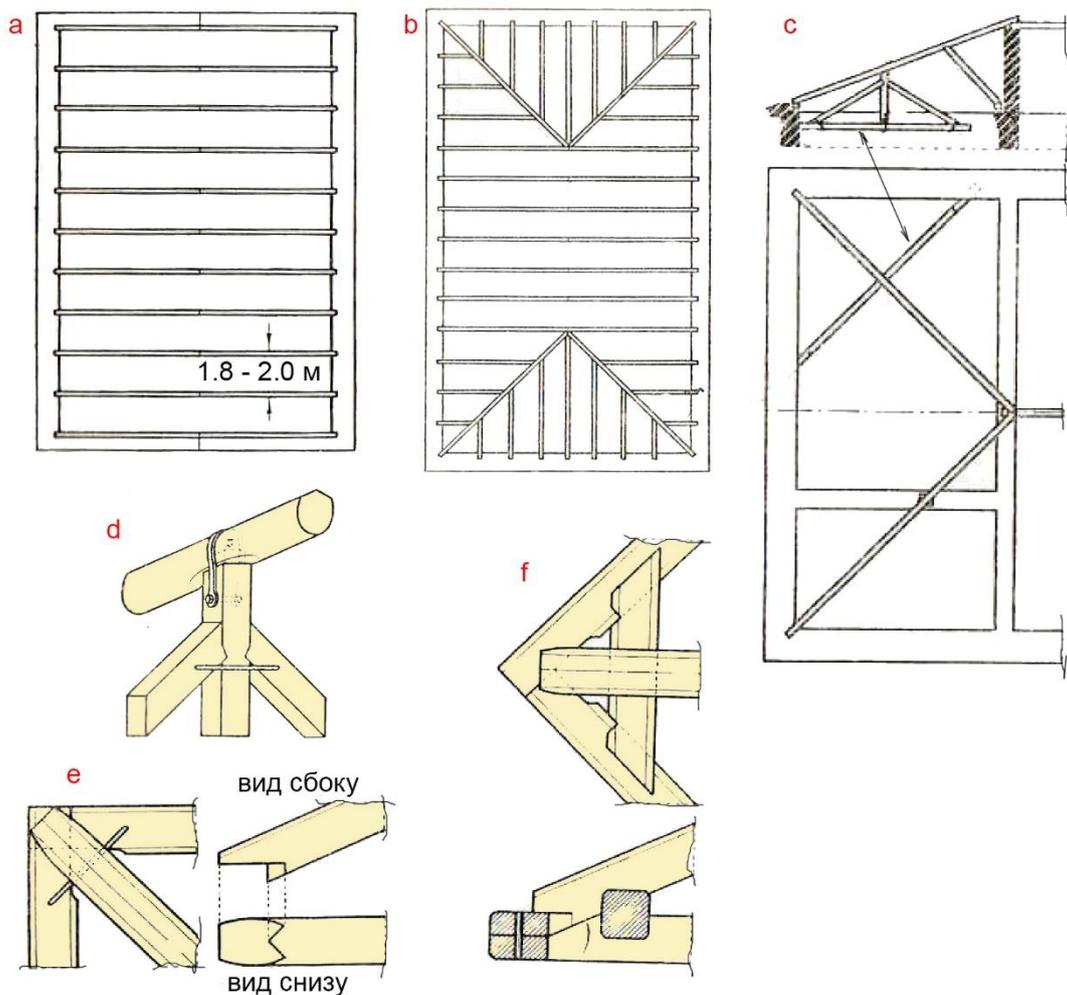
Схемы размещения стропильных элементов крыши: а – план стропил щипцового одно- или двускатного покрытия; б – план стропил вальмового покрытия; с – схемы расположения дополнительных опор угловой стропильной ноги – подкос, висячая ферма, стойка; д – опирание угловой ноги на бабку висячей фермы; е – опирание угловой ноги на связку мауэрлатов; ф – опирание длинной угловой балки на вспомогательный ригель [33]
